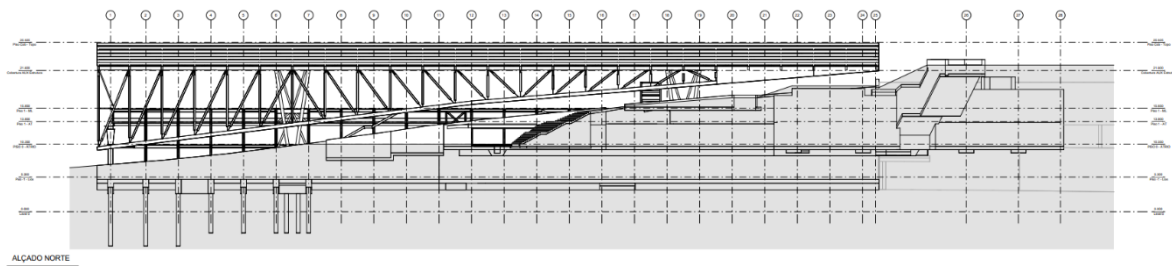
Alçado Norte – detalhe da treliça Norte e alçado dos pilares de apoio em “V”
